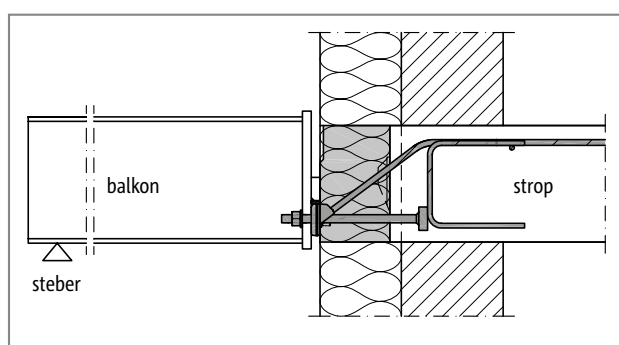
Schöck Isokorb® XT tip SQP: priključek na železobetonski strop; monolitna konstrukcija stene
